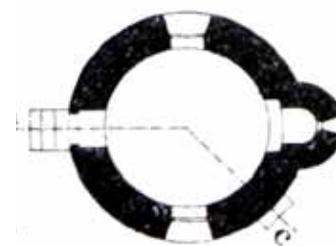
Grundriss Tigring, M 1:1200. Gruber 1924
